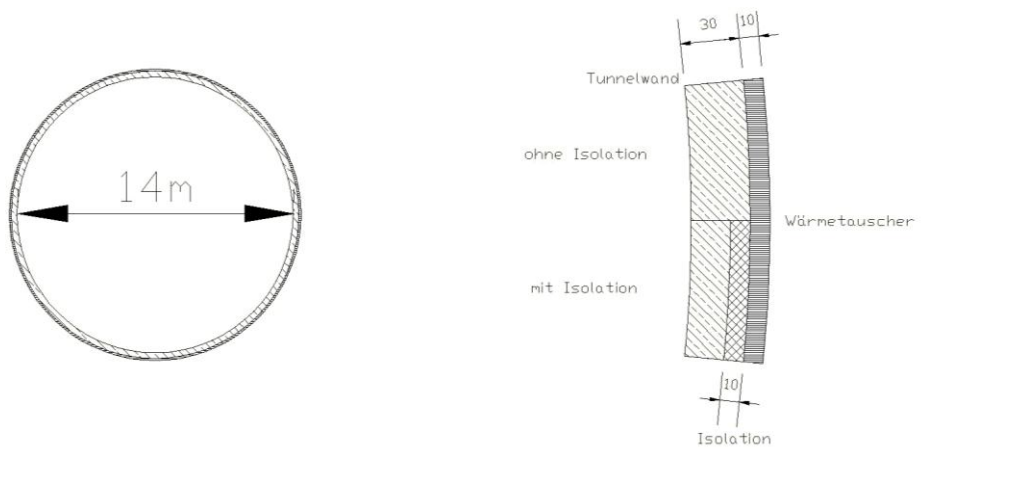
Rundes Tunnelprofil: Flächenkollektorsystem mit Wärmetauscher rundum in der Tunnelwand, links Querschnitt senkrecht zur Tunnelachse, rechts Vergrößerung Querschnitt durch Flächenkollektorsystem (Bemassung in cm)
